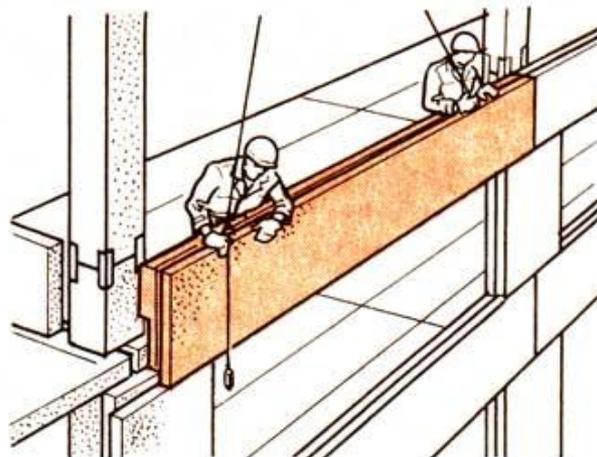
Схема монтажа стеновых ограждающих панелей, кран расположен между кассетой и стеной:
